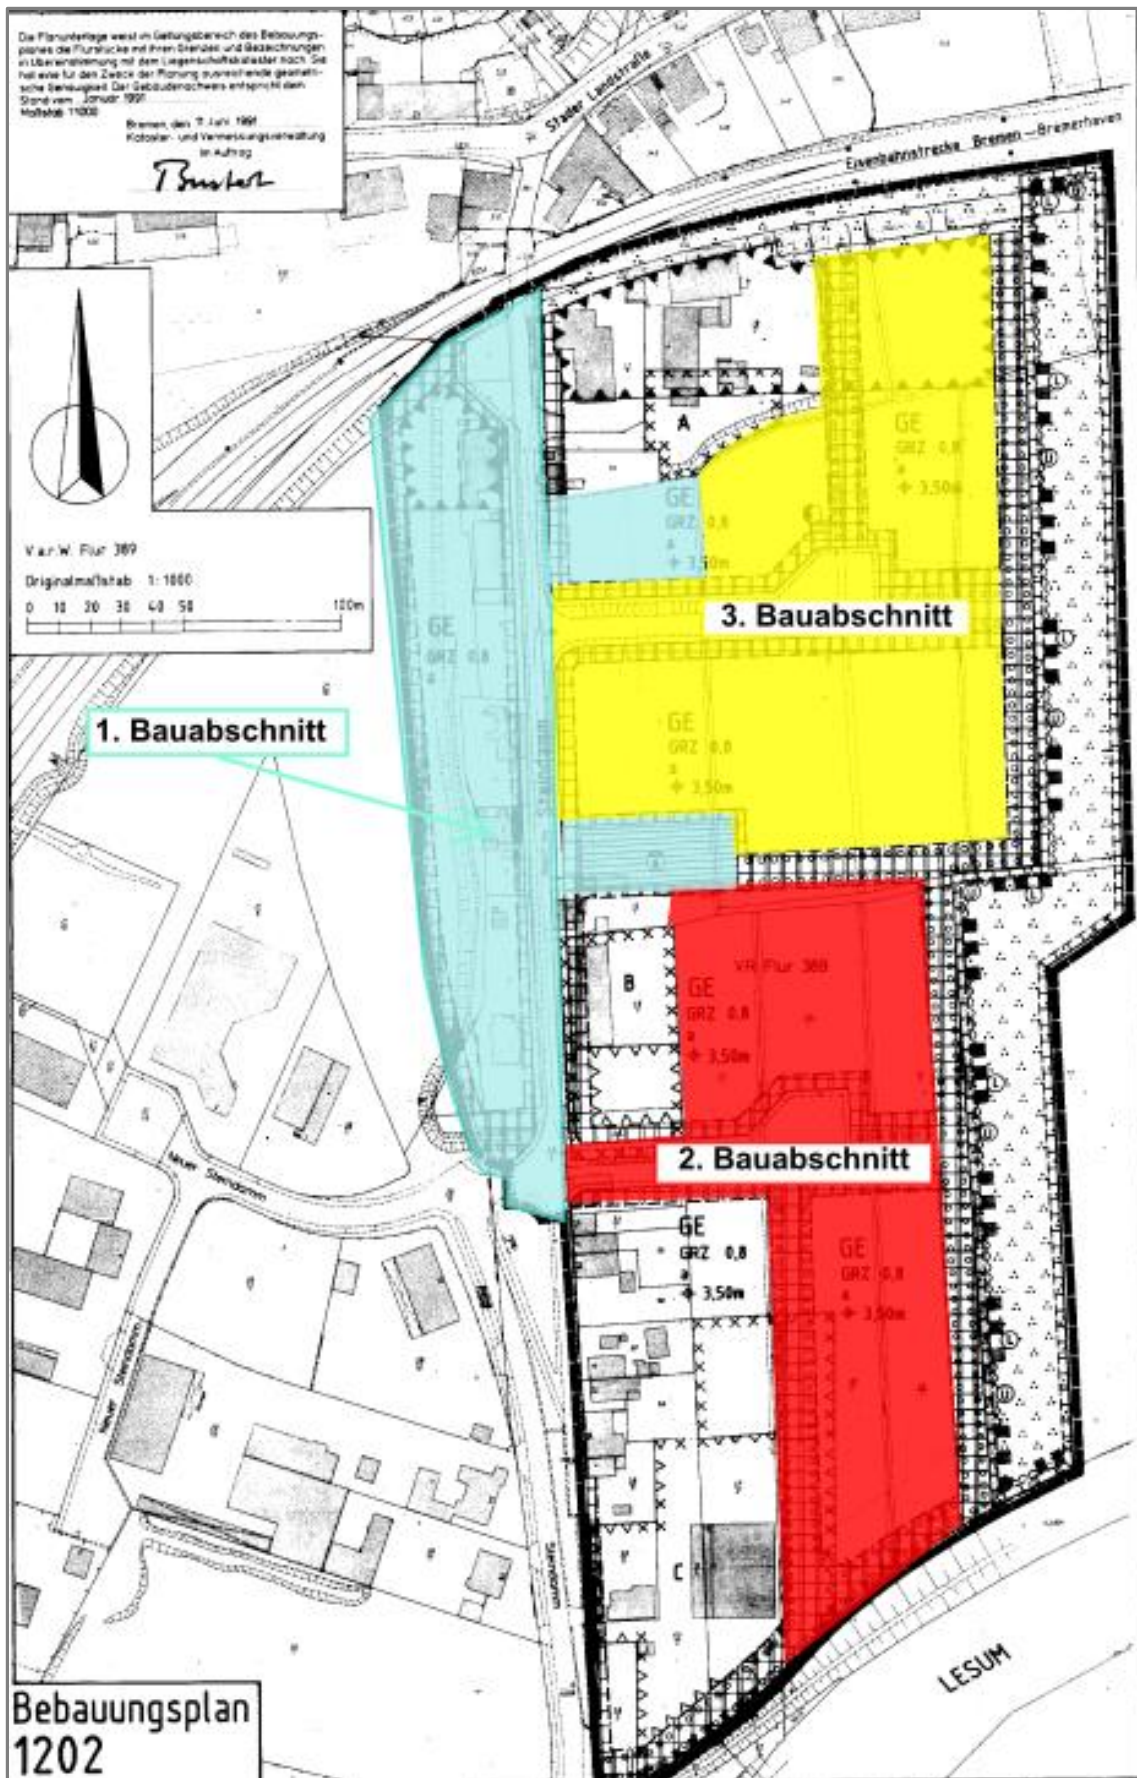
B-Plan 1202 mit Darstellung der einzelnen Bauabschnitte
